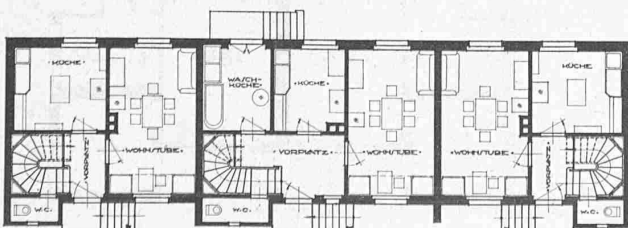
und 34 Grundrisse, Abb. 35 Rück-Passade. — Masstab 1:250.
